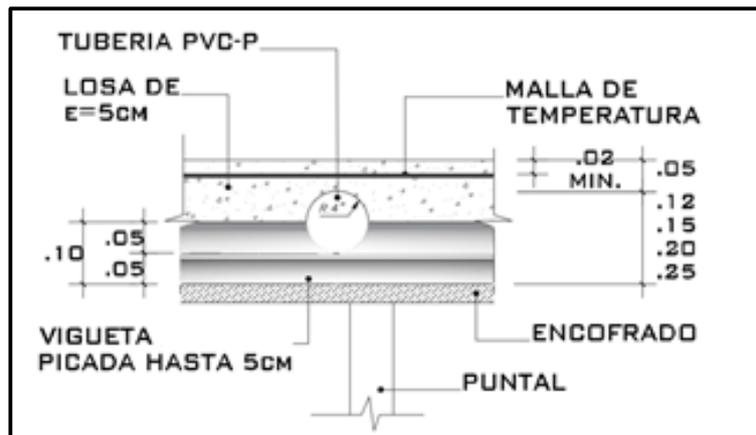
Detalle de vigueta cortada por tubería de desagüe.
